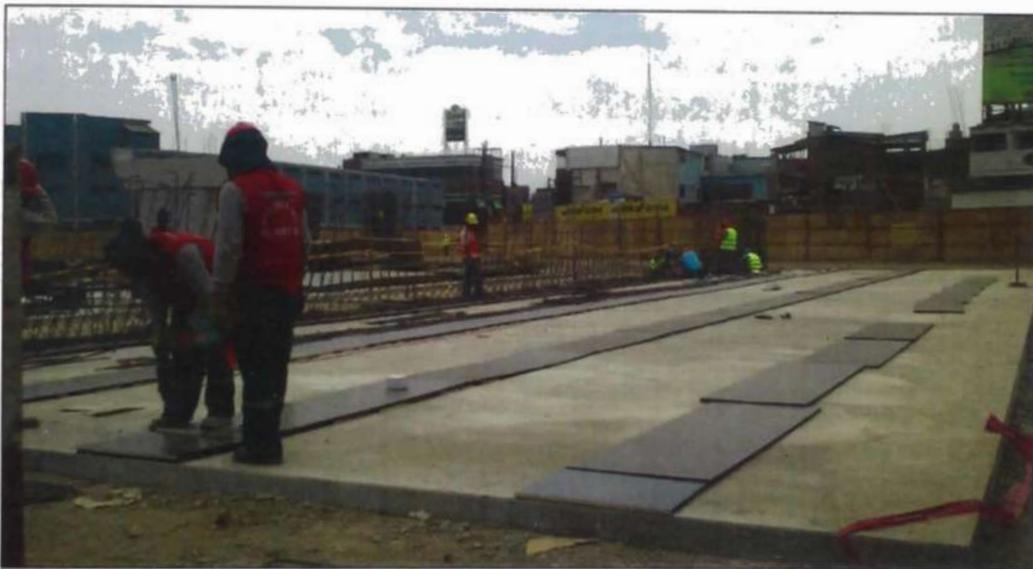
Colocación del Fondo de Encofrado en Viga Postensada
